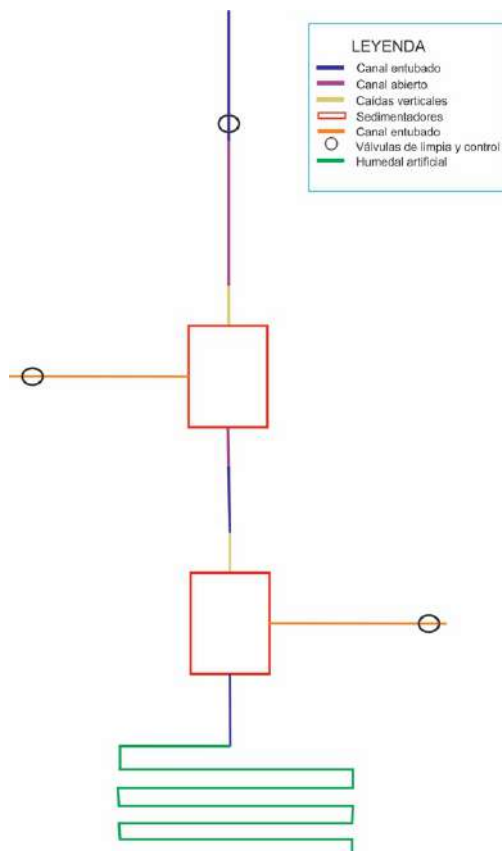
Estructuras hidráulicas construidas por el C.U. Shallap-Huapish-Toclla.
